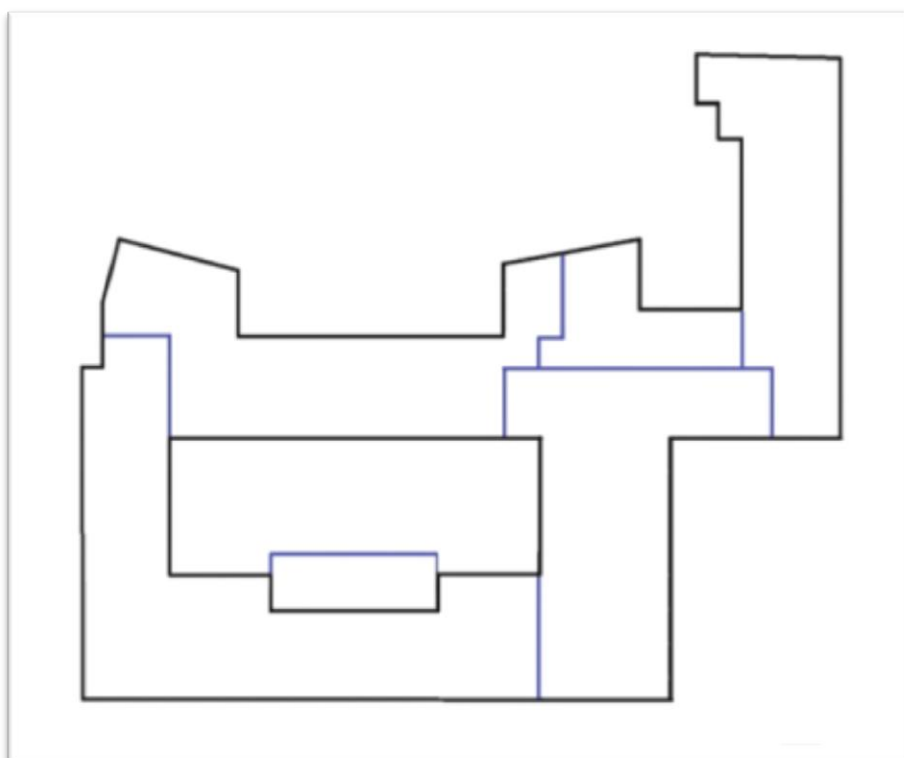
Grundriss des Gebäudekomplexes
